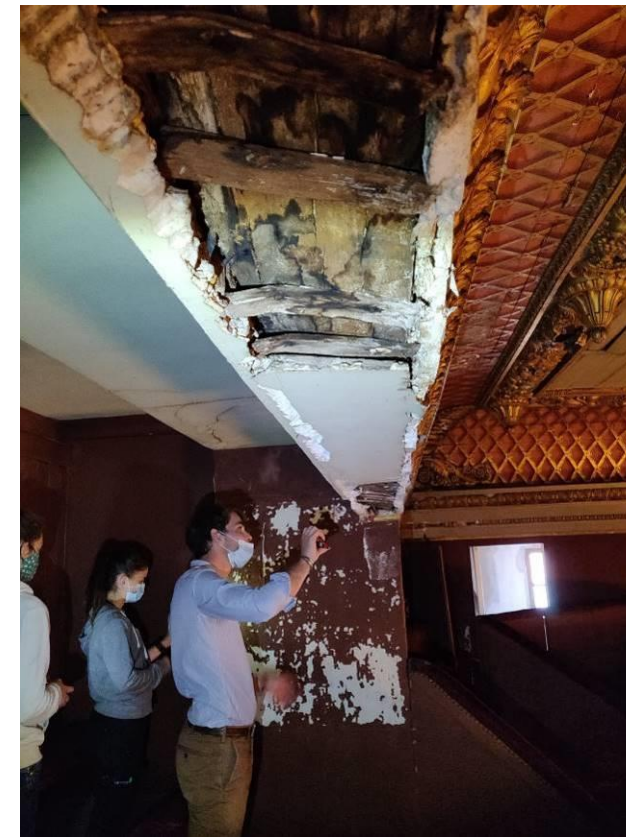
Plancher haut du 3^{ème} balcon – Enduit disparu sur poutre linteau ouverture
